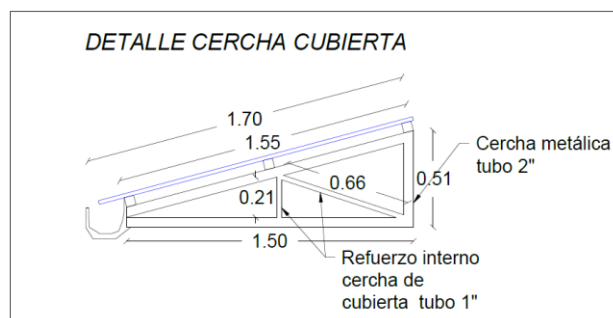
Detalle cercha de cubierta para zona de lavaplatos y lavadero.
